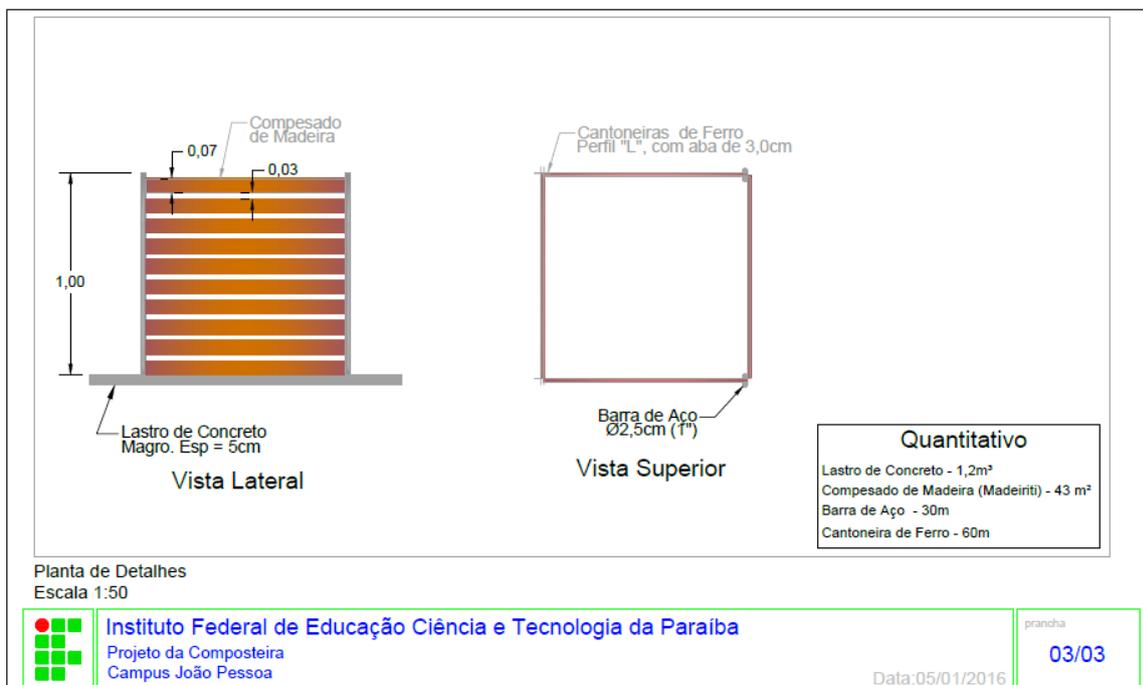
Projeto da Composteira Planta 03/03 - Vistas
